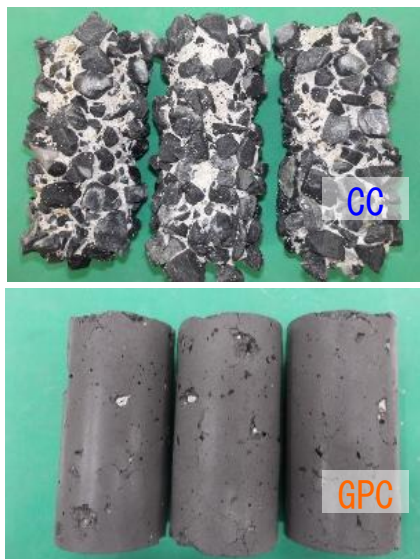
耐酸性試験後の試験体 (上 CC, 下 GPC)
